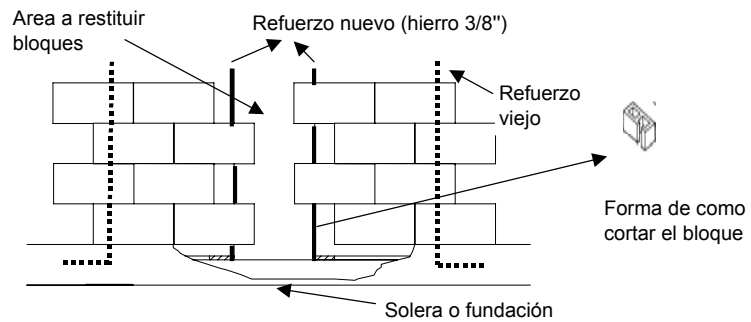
Reparación de paredes de bloque de concreto (grietas verticales > de 10mm)
